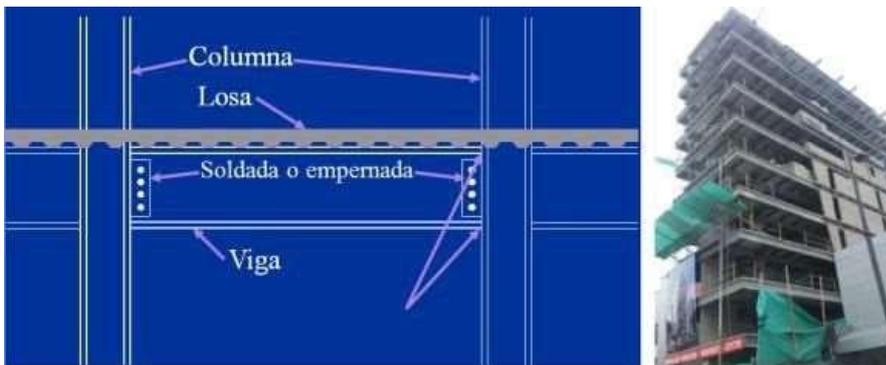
Tipo de sistema estructural: Pórtico de acero laminado (S1).
